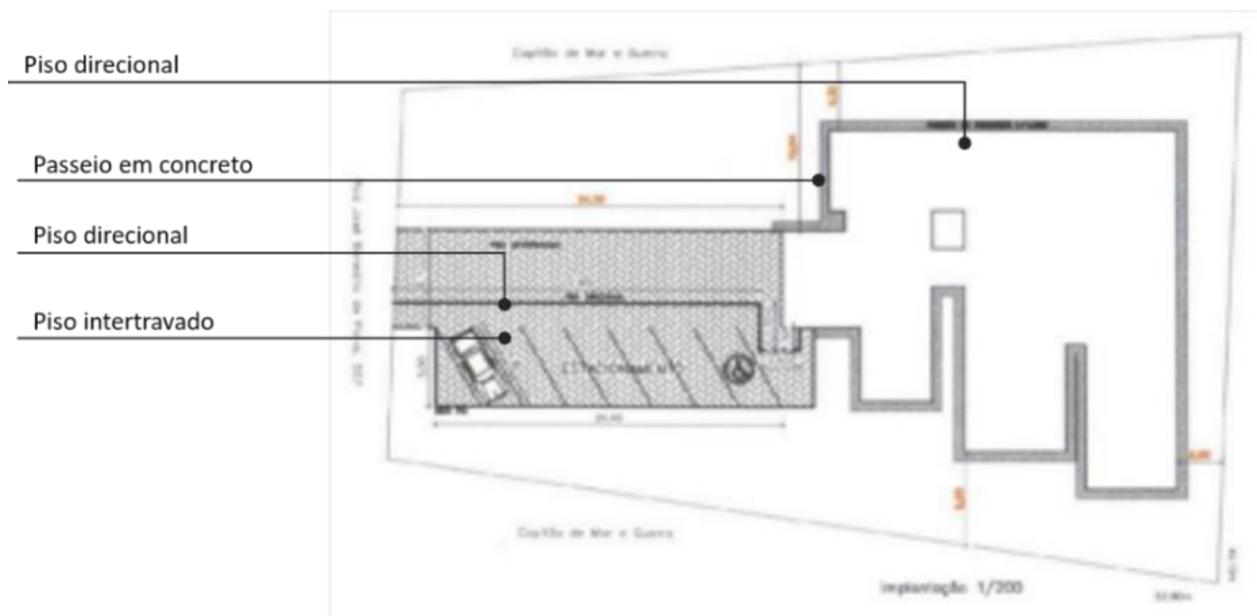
Planta baixa do CAPS II de São Gonçalo de Sapucaí
